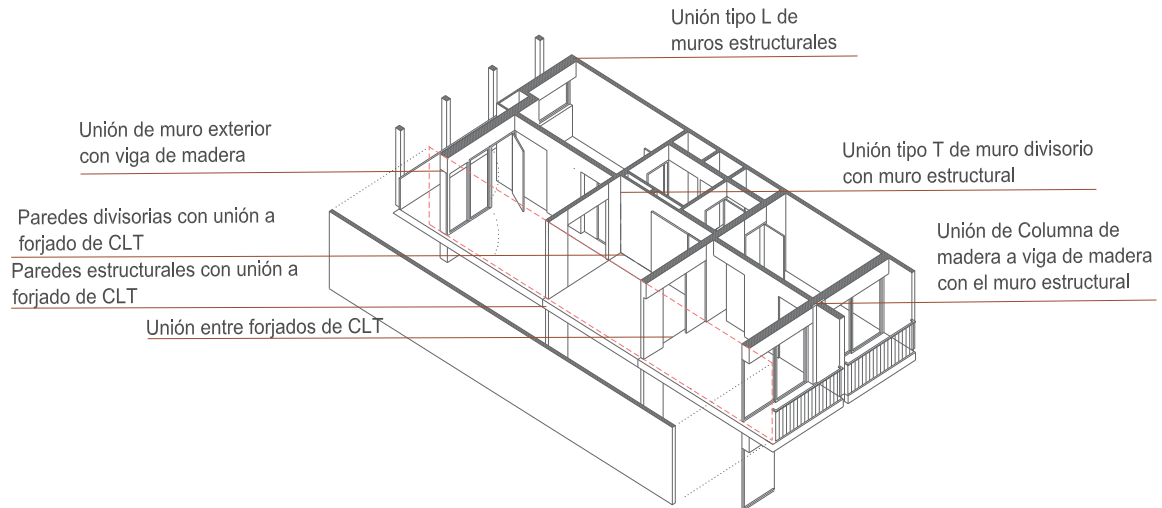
Plano departamento tipo del Bloque 6x6.
